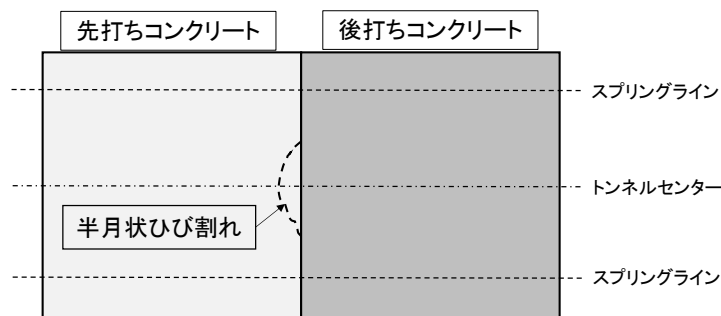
半月状ひび割れの発生イメージ (平面図)
